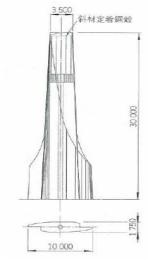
木曾川橋與揖斐川橋橋塔斷面圖及施工
